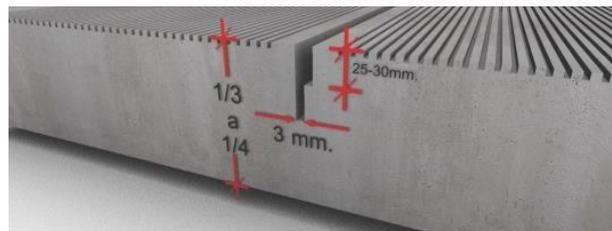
Detalles y dimensiones del corte de las juntas longitudinales y transversales.
